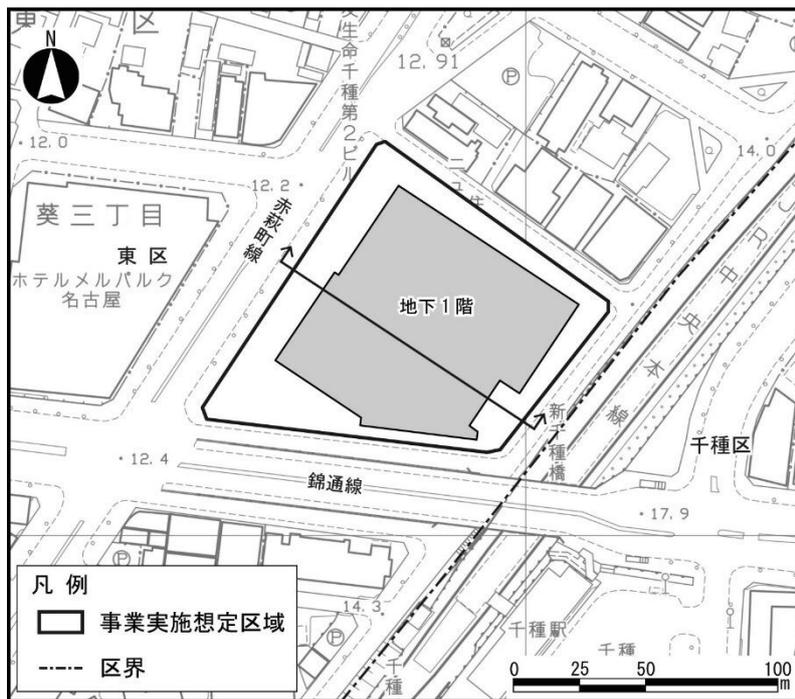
(1) 地下1階平面図及び断面図 (A案)
